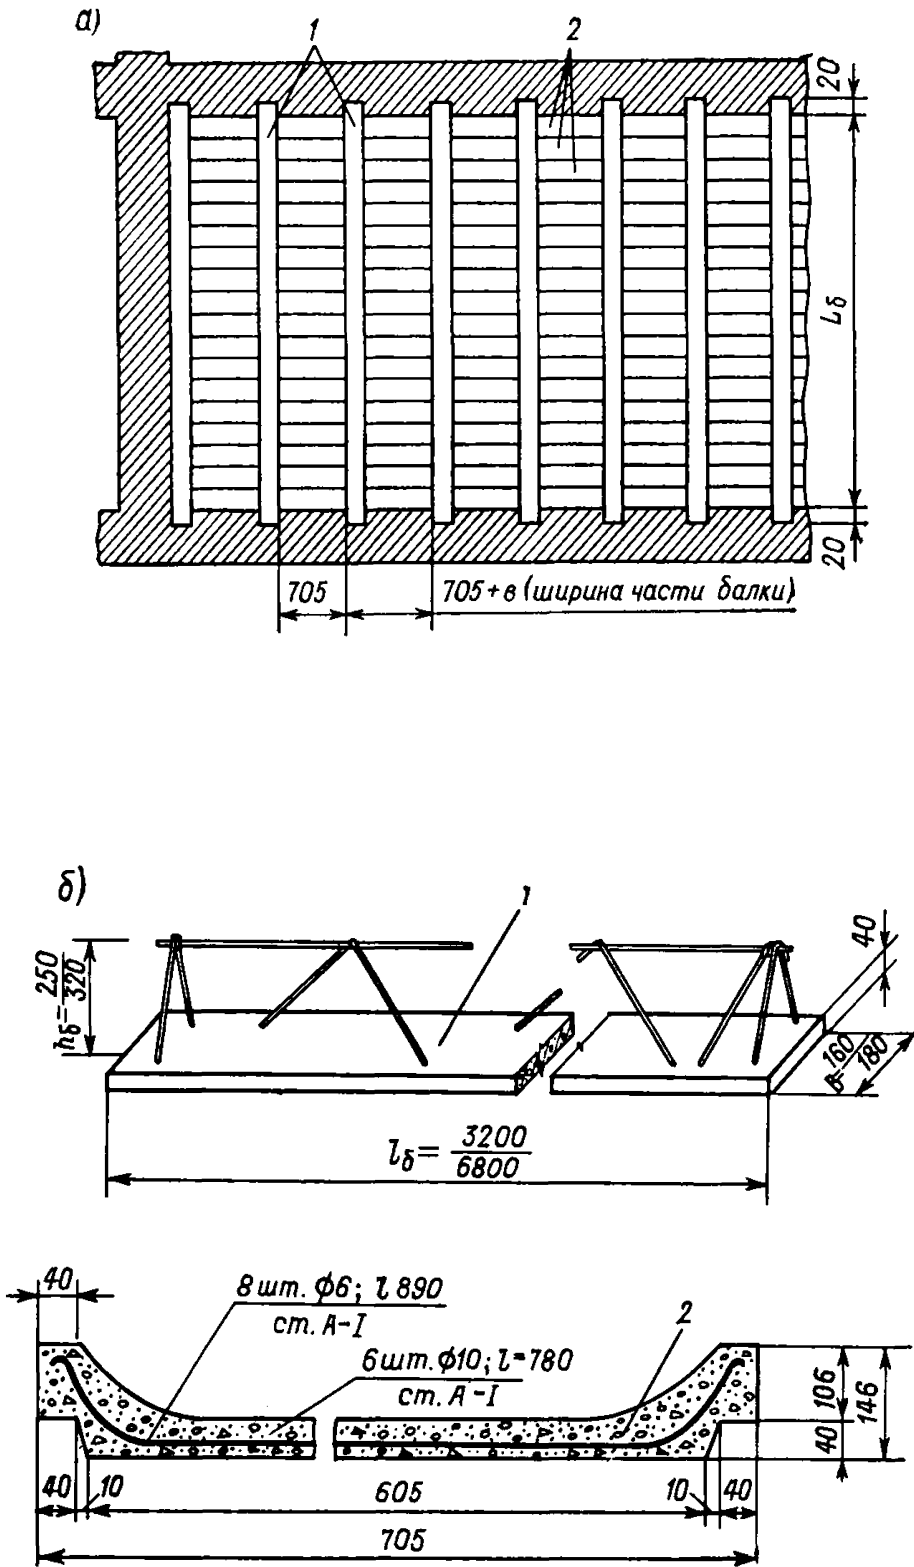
Схема устройства сборно-монолитного перекрытия
